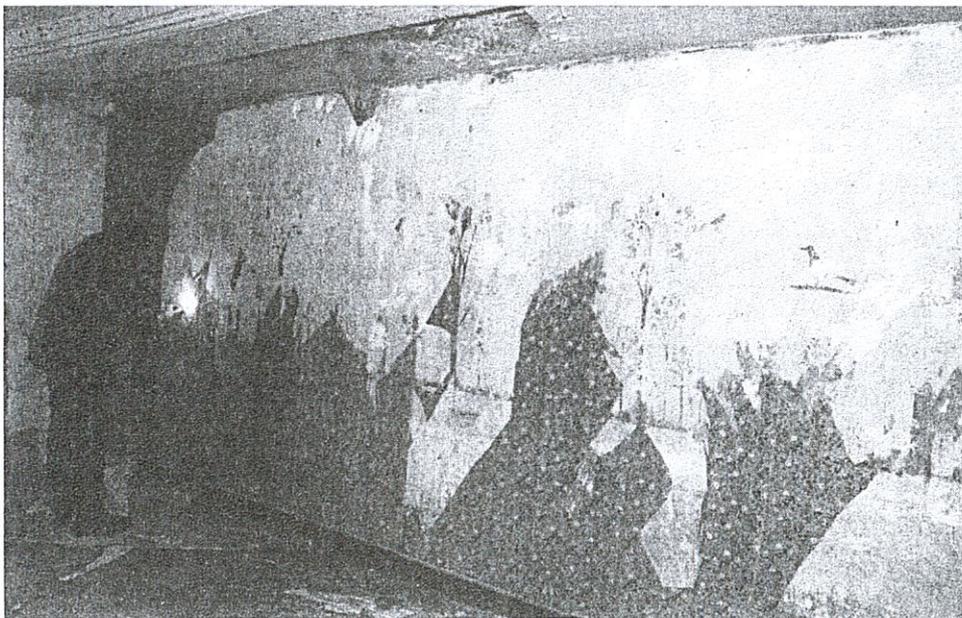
vue du mur opposé (cloison obturant une fenêtre de la façade principale). Frise décorée dans la partie médiane. État du mur et multiples rebouchages au plâtre. En haut, poutre et niveau de plafond en place (XVIIe s.)
